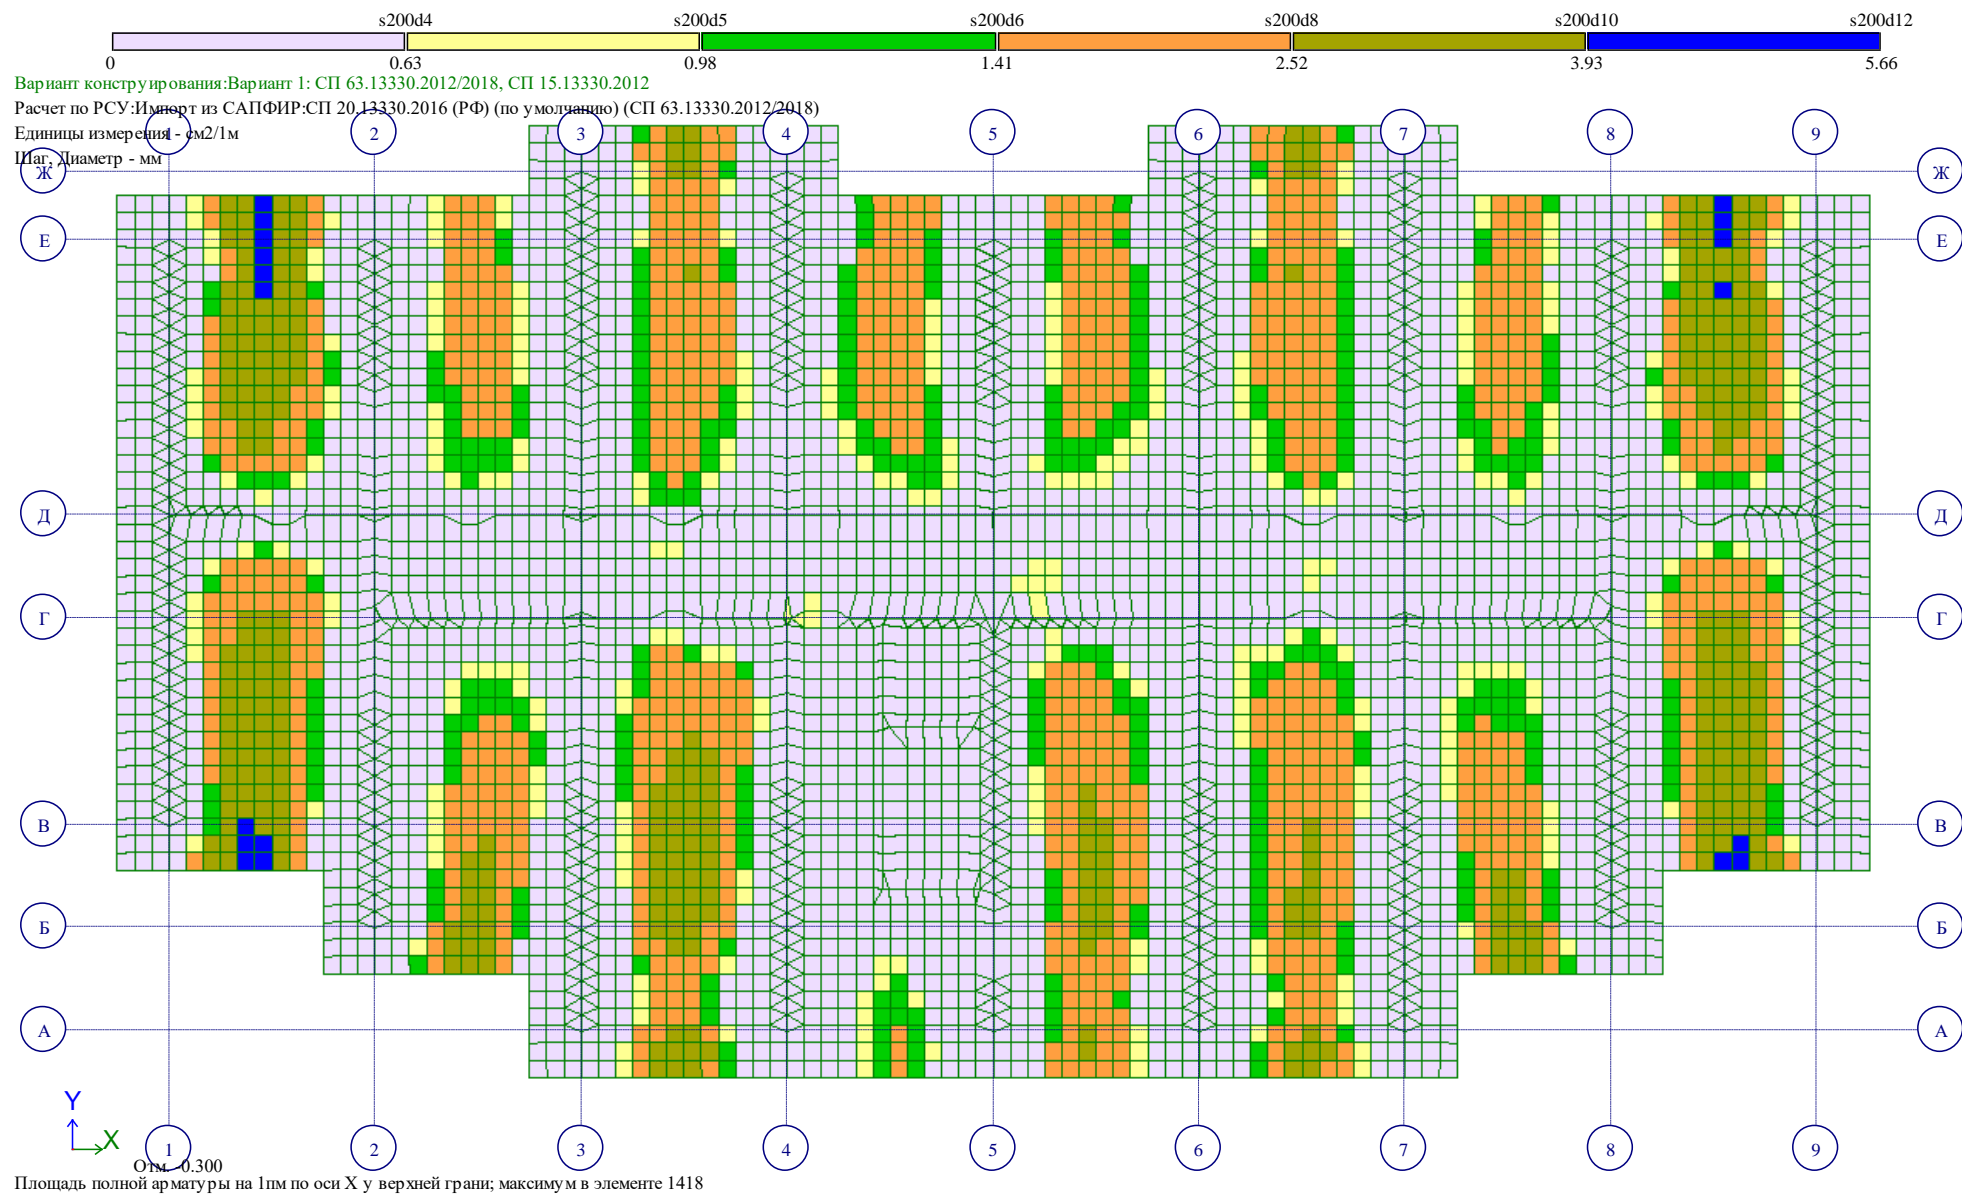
Площадь полной арматуры на 1мм по оси X у верхней грани
